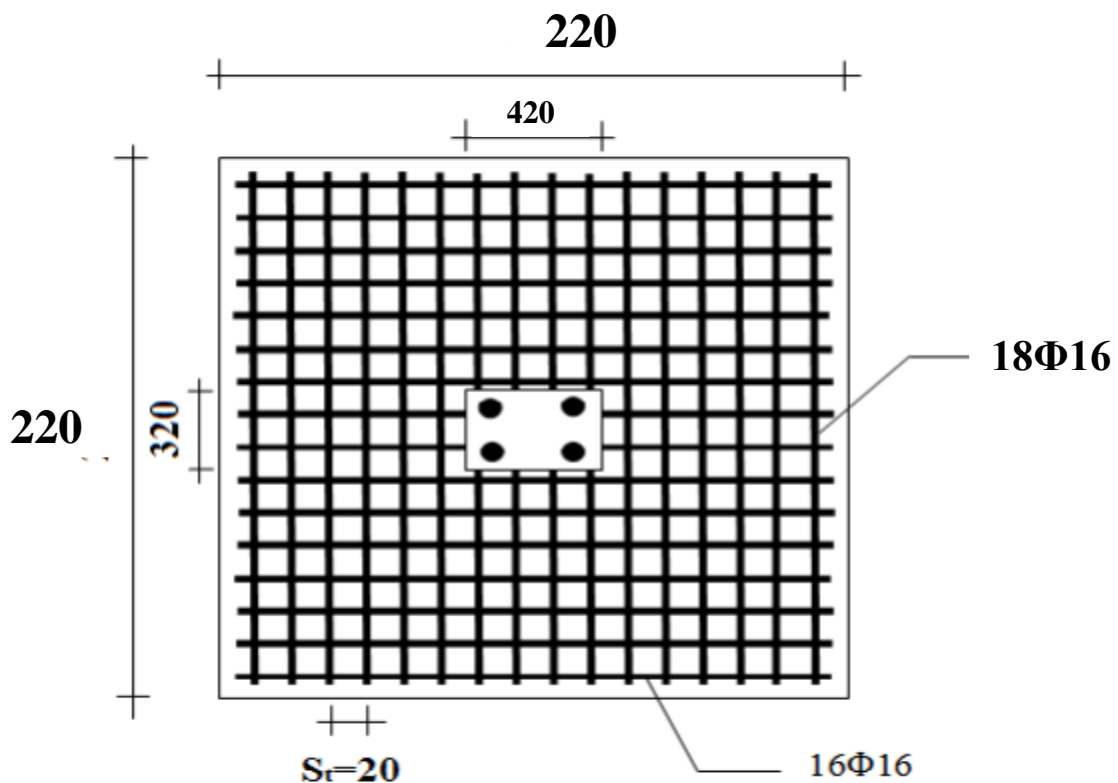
Schéma de ferrailage de semelle isolée.
